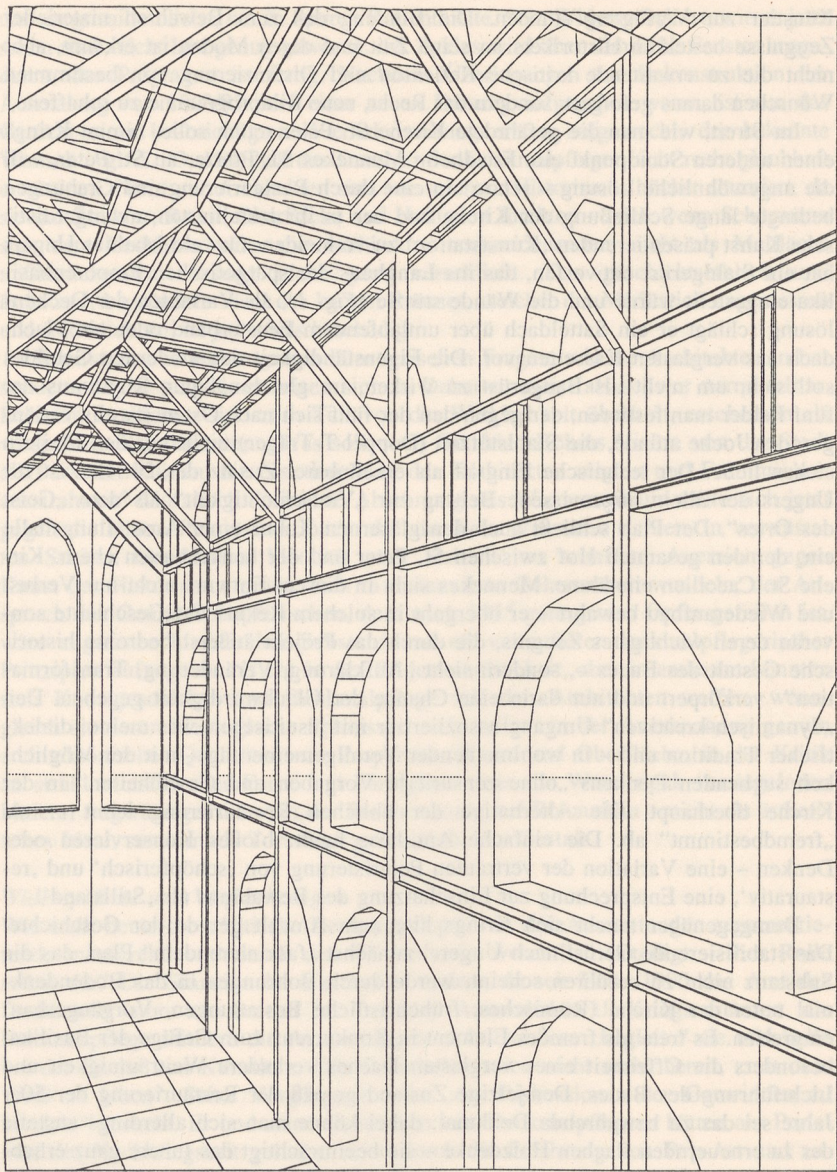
Köln, St. Peter. Von O. M. Ungers vorgeschlagene, eingestellte Stahlkonstruktion mit Glasdach (nach: Kunst und Kirche 1/92, S. 59)
